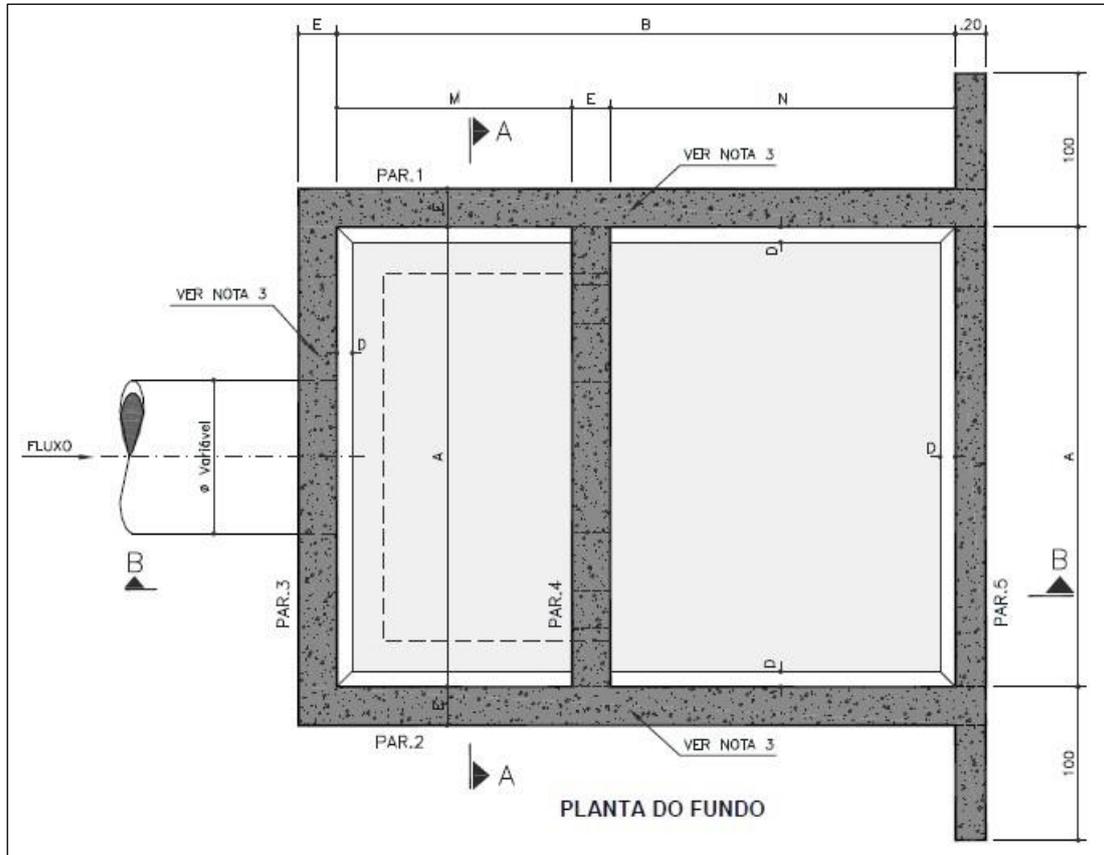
Detalhe de planta de fundo do dissipador de impacto.
